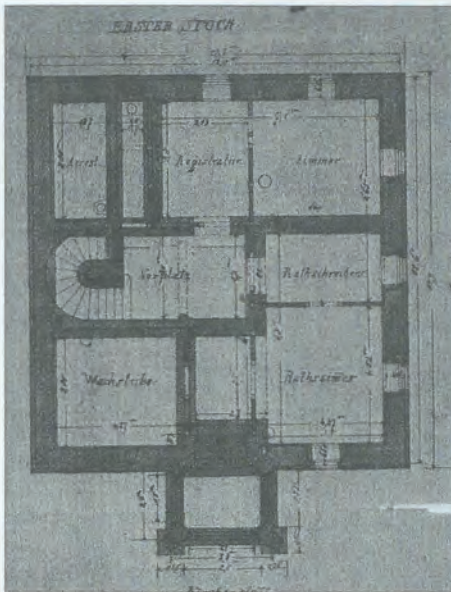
Plan III, Grundriss erstes Stockwerk. Generallandesarchiv Karlsruhe, Az.: 377/15231
